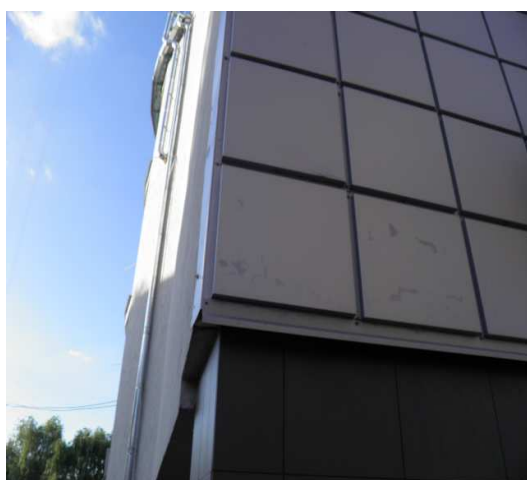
Фото та конструкція будівлі з вентиляльованим фасадом
